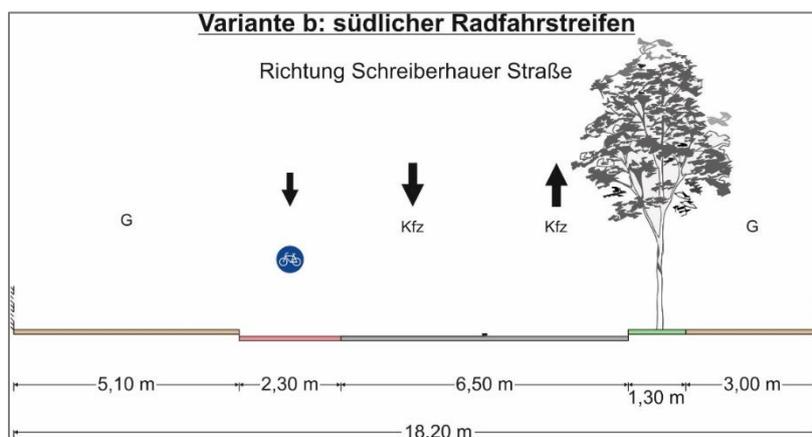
Variante b: Querschnitt Schreiberhauer Straße / Hauffstraße
